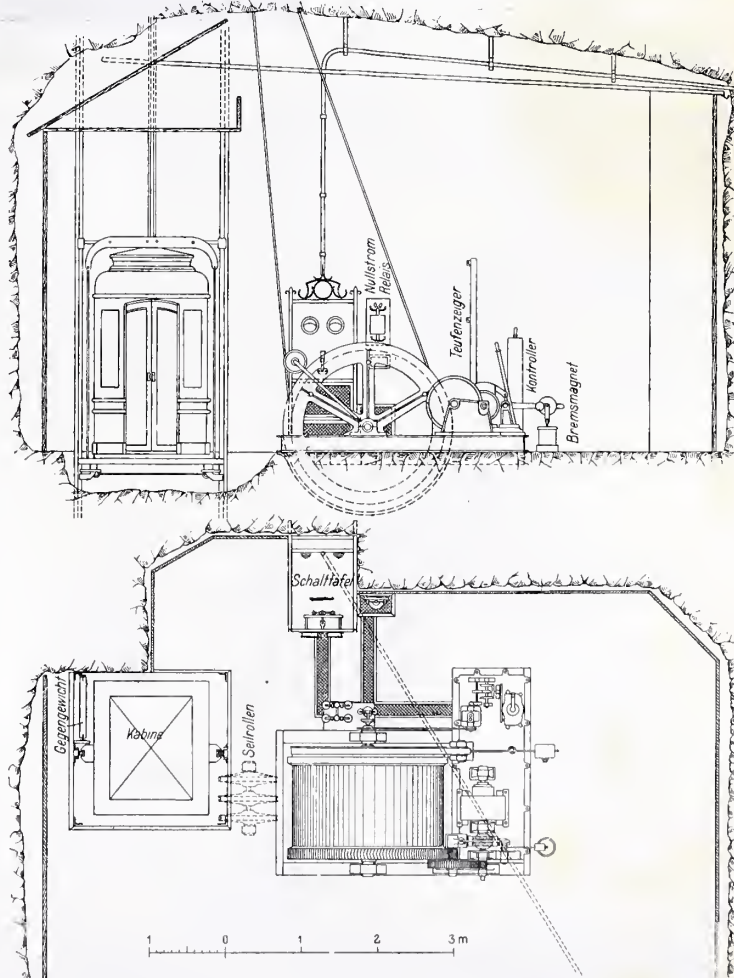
Die Maschinenkammer mit der Aufzugswinden-Einrichtung.
